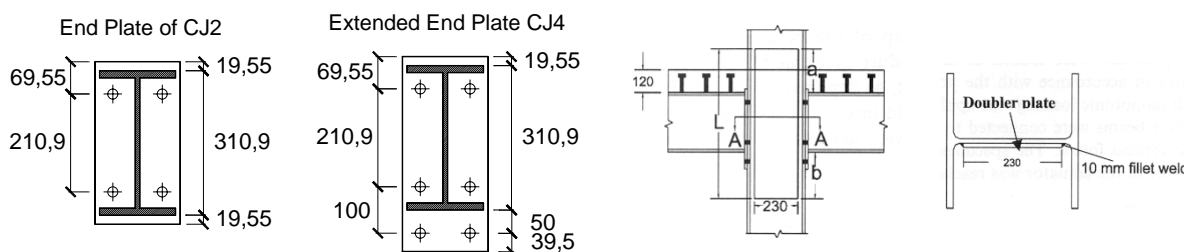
a) Representação geométrica da ligação metálica número 8, b) metálica número 9, c) pormenor da laje e d) pormenor do reforço na alma do pilar da ligação 8.
